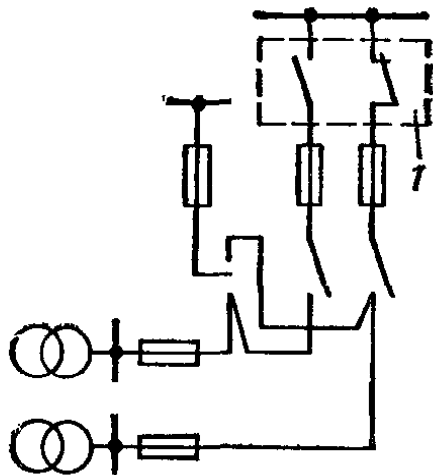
Схема электропитания жилого дома высотой 17 этажей и выше:
